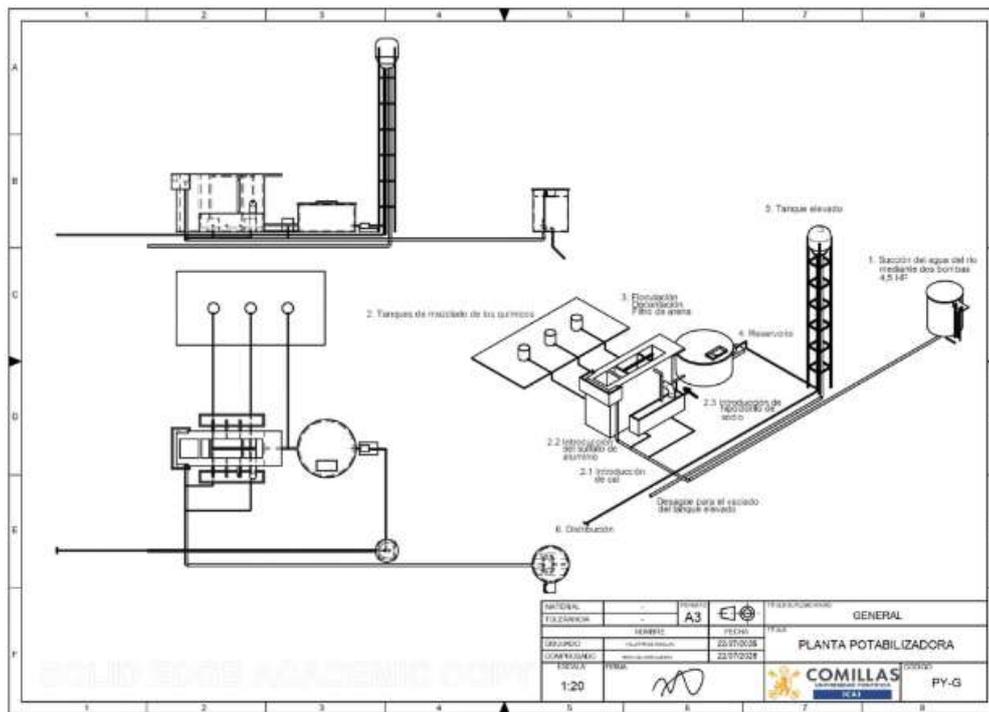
Vista general de la planta con alzado, planta y miniatura 3D con explicación
